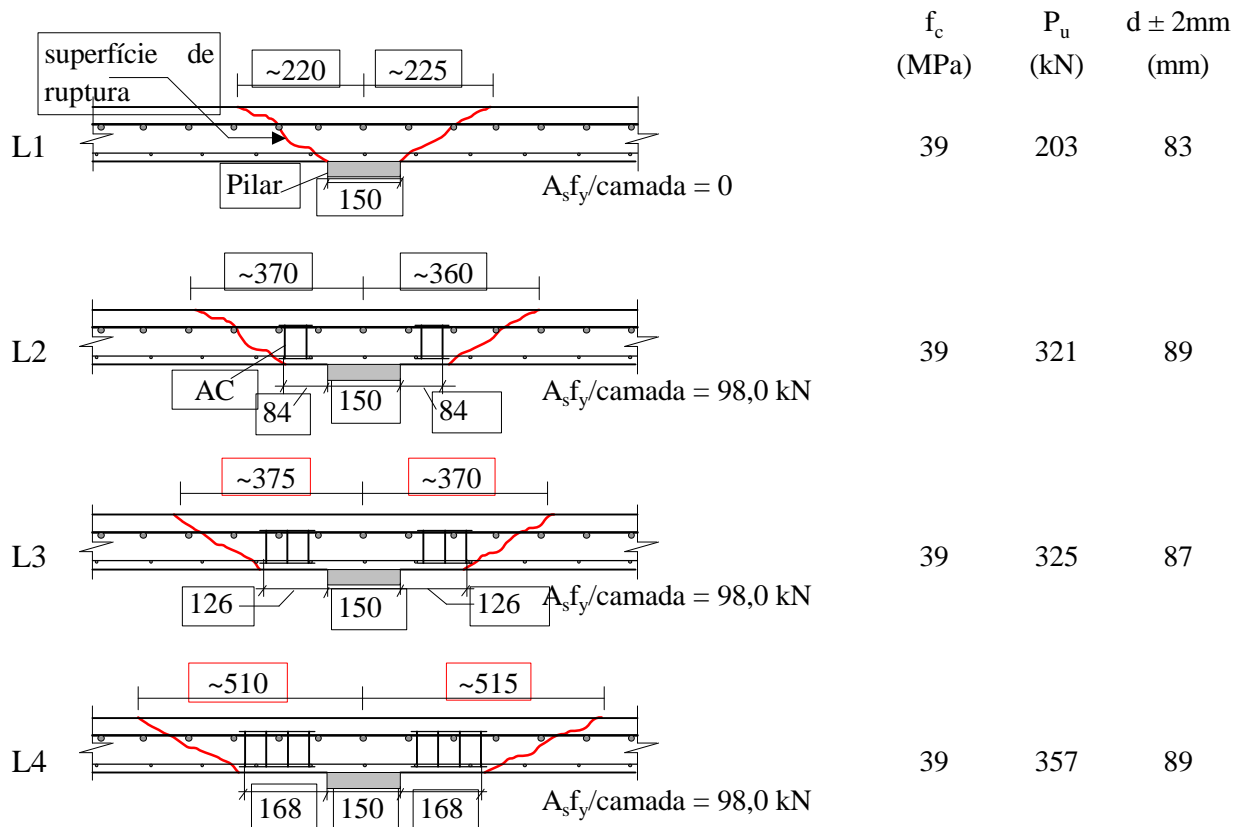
Esquema da superfície de ruptura das lajes do Grupo 1 (dimensões em mm)
